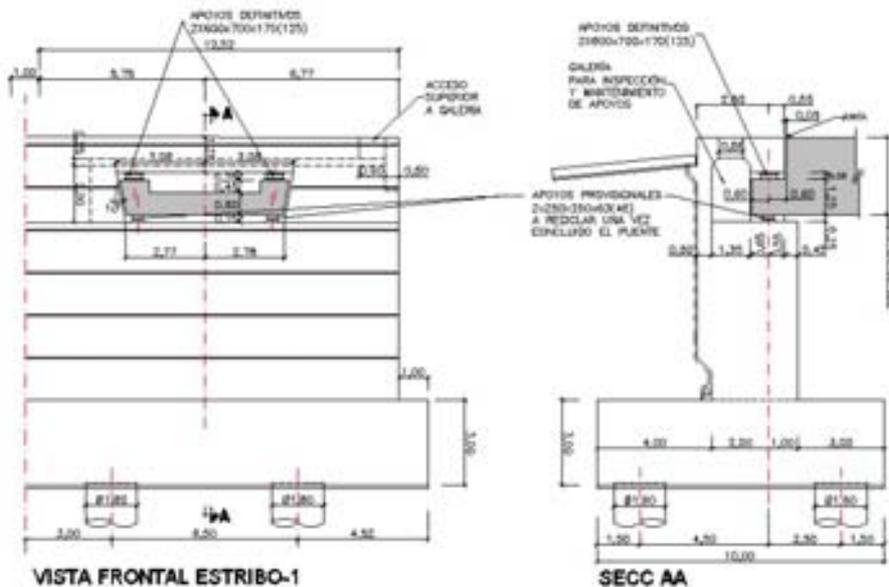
Vista del alzado y sección de los estribos con los detalles de los apoyos inversos.
